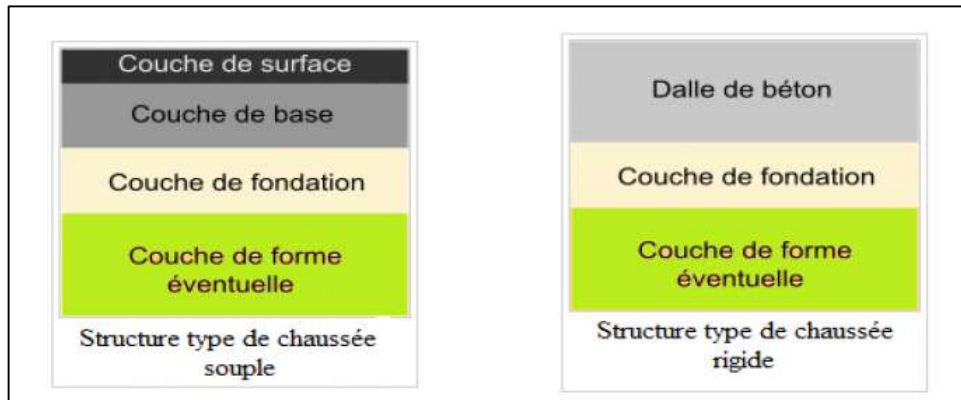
Structure type d'une chaussée souple et d'une chaussée rigide
